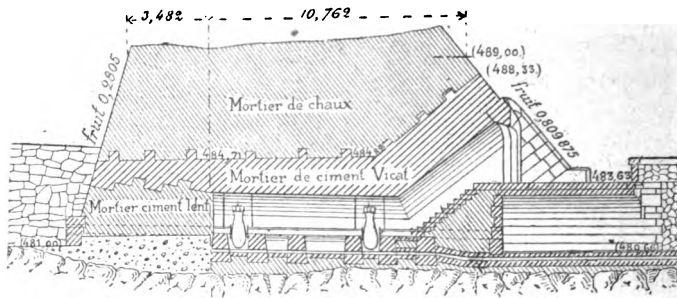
Coupe de la galerie de vidange du barrage du Ternay.
